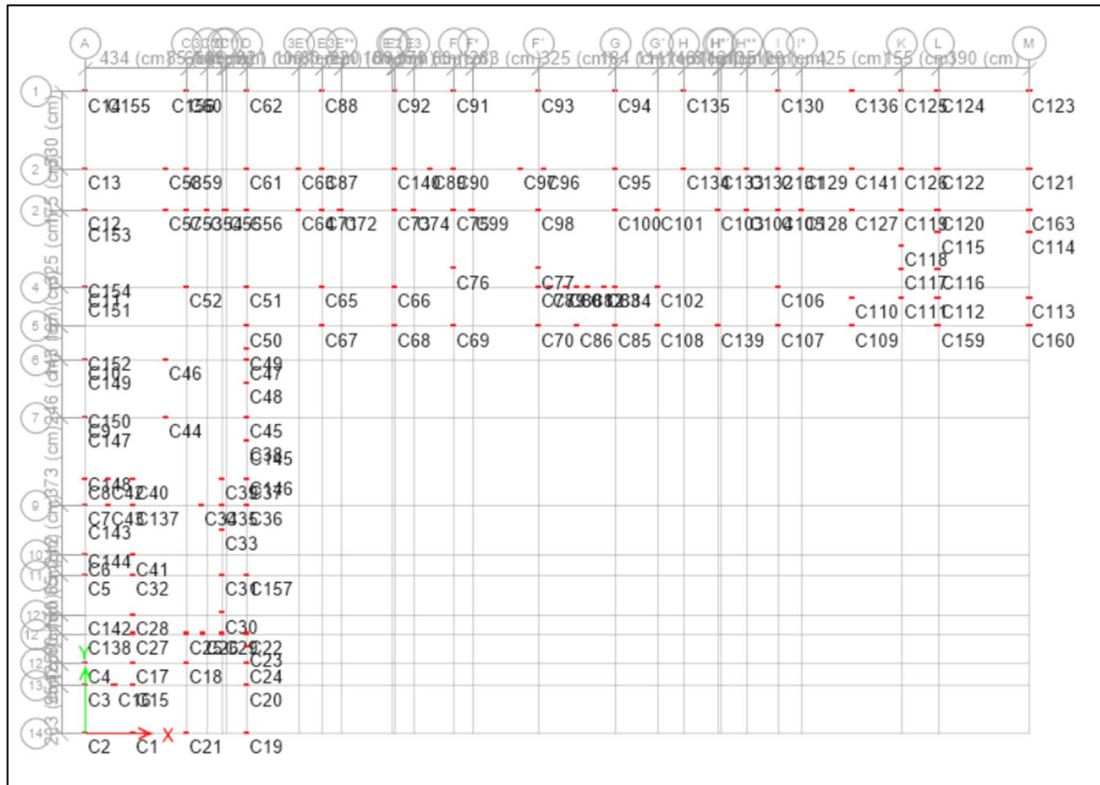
COLUMNAS (NIVEL 2,4 M)
